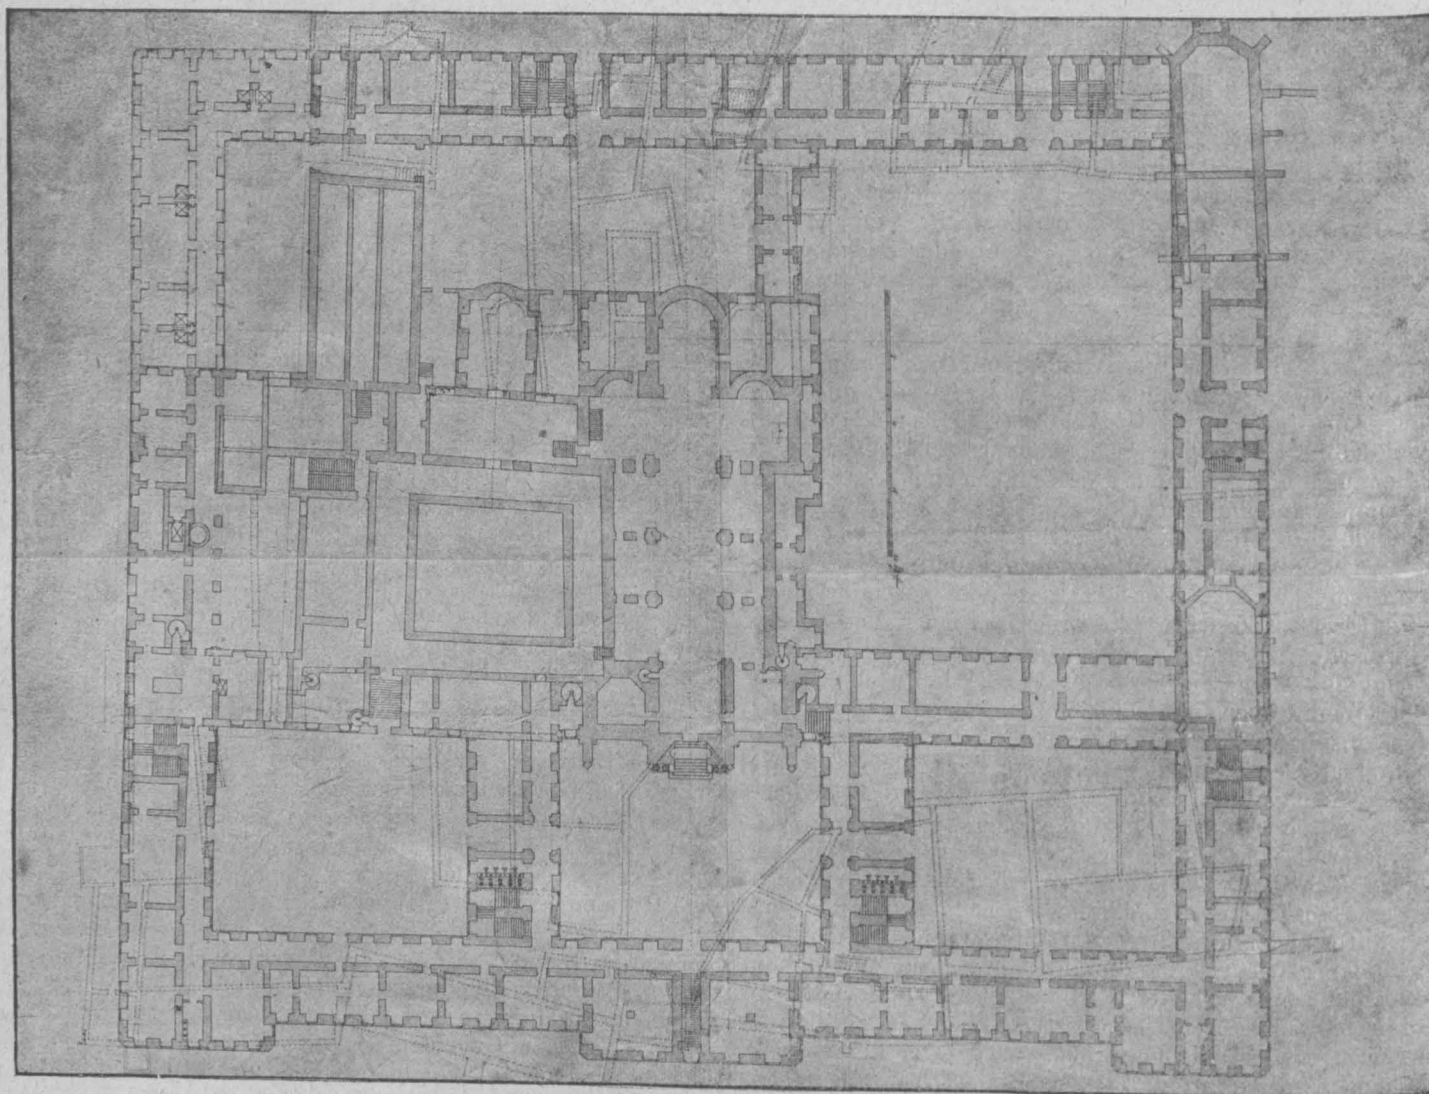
Jakob Prandauers Plan für den im Jahre 1706 projektierten Neubau des Stiftes Klosterneuburg (I.)
